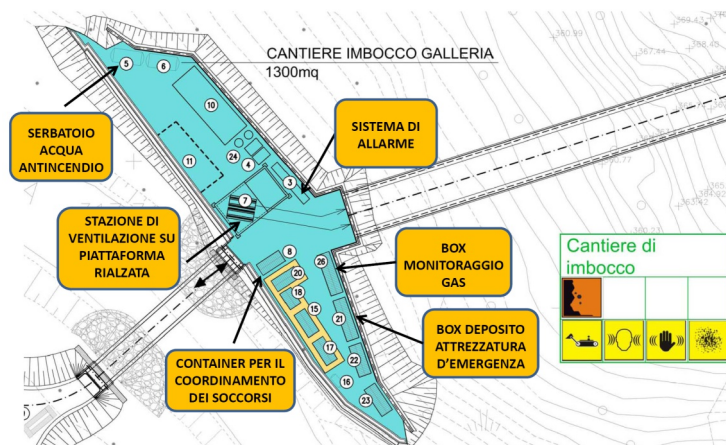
Fattori di rischio rilevati ed elenco degli apprestamenti desunti dalle NIR.
